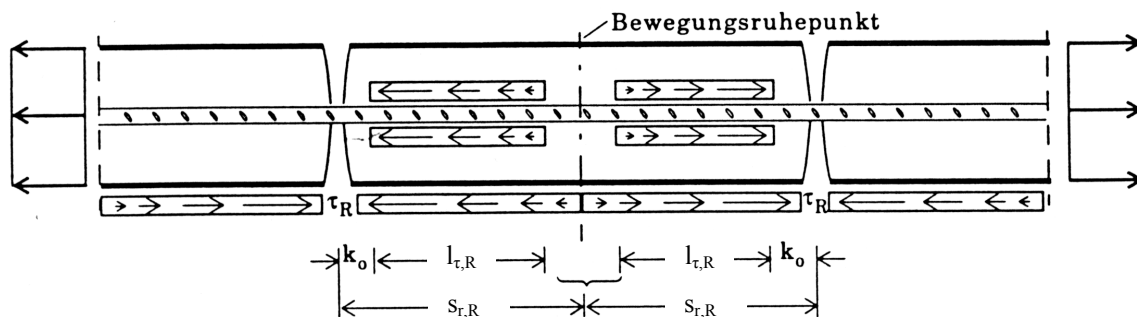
Krafteinleitung in den Beton durch Bewehrung und Reibung /47/
